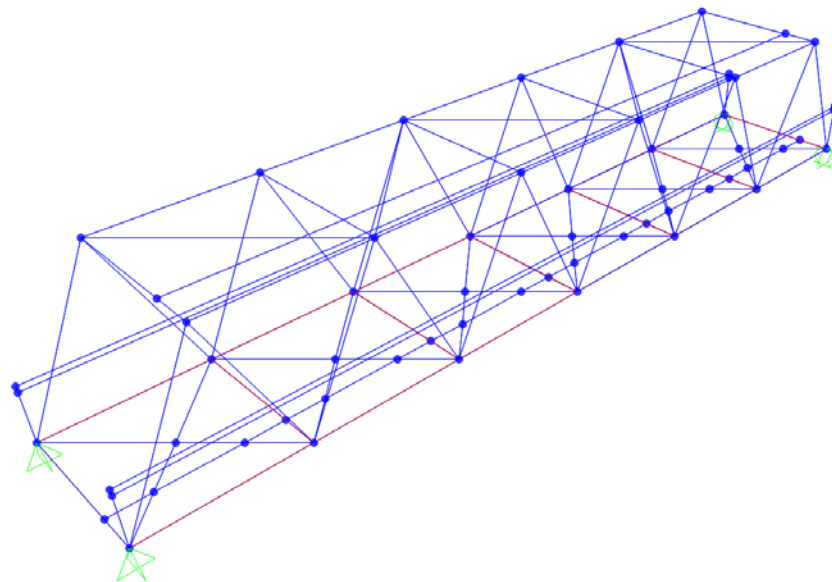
Estructura apoyos articulados y móviles.
